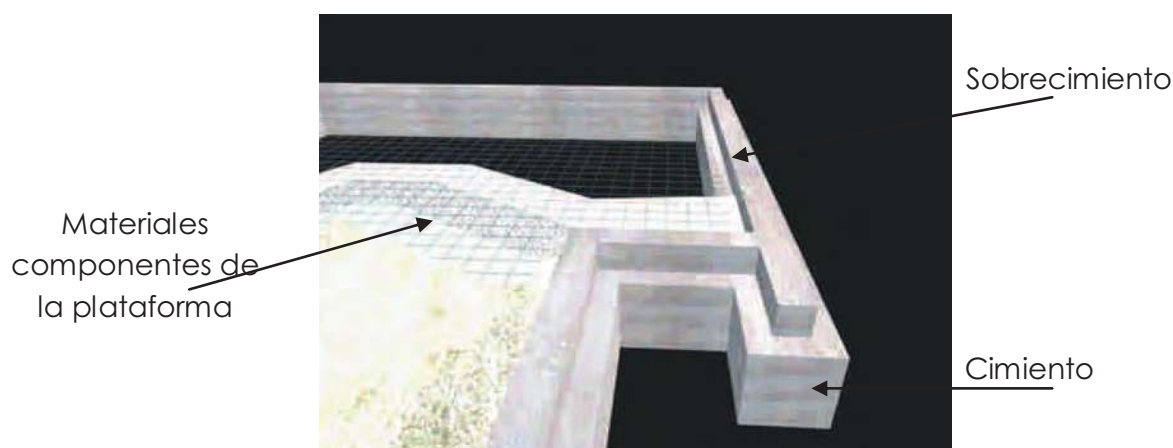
, Cimentación continua, solución ideal para cimentación superficial para vivienda estructurada en madera. Fuente, *"La Construcción de Viviendas en Madera"*,
